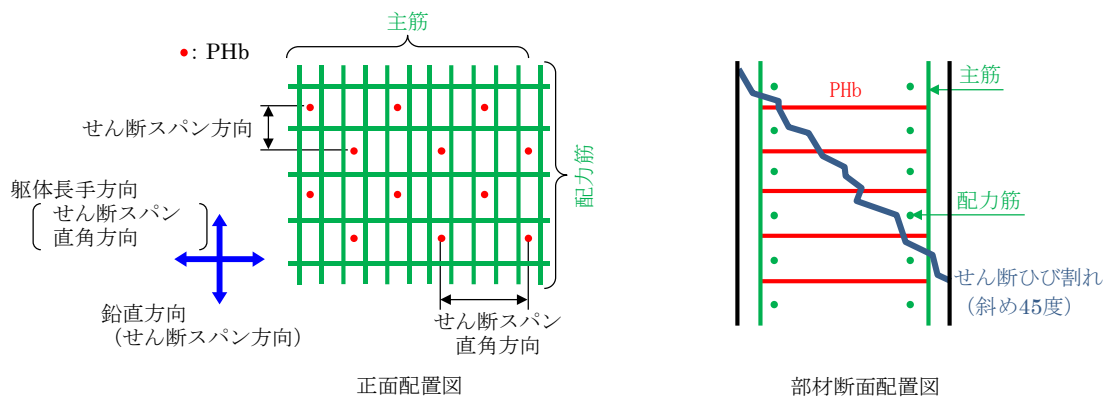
せん断補強筋正面配置図及び部材断面配置図
